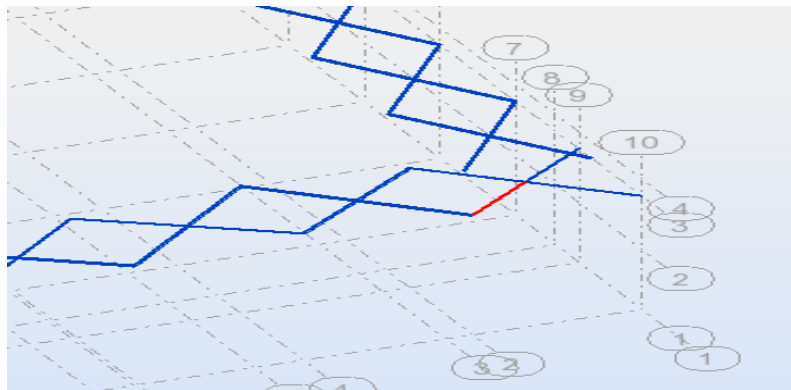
Diagonale la plus sollicitée dans la poutre au vent
